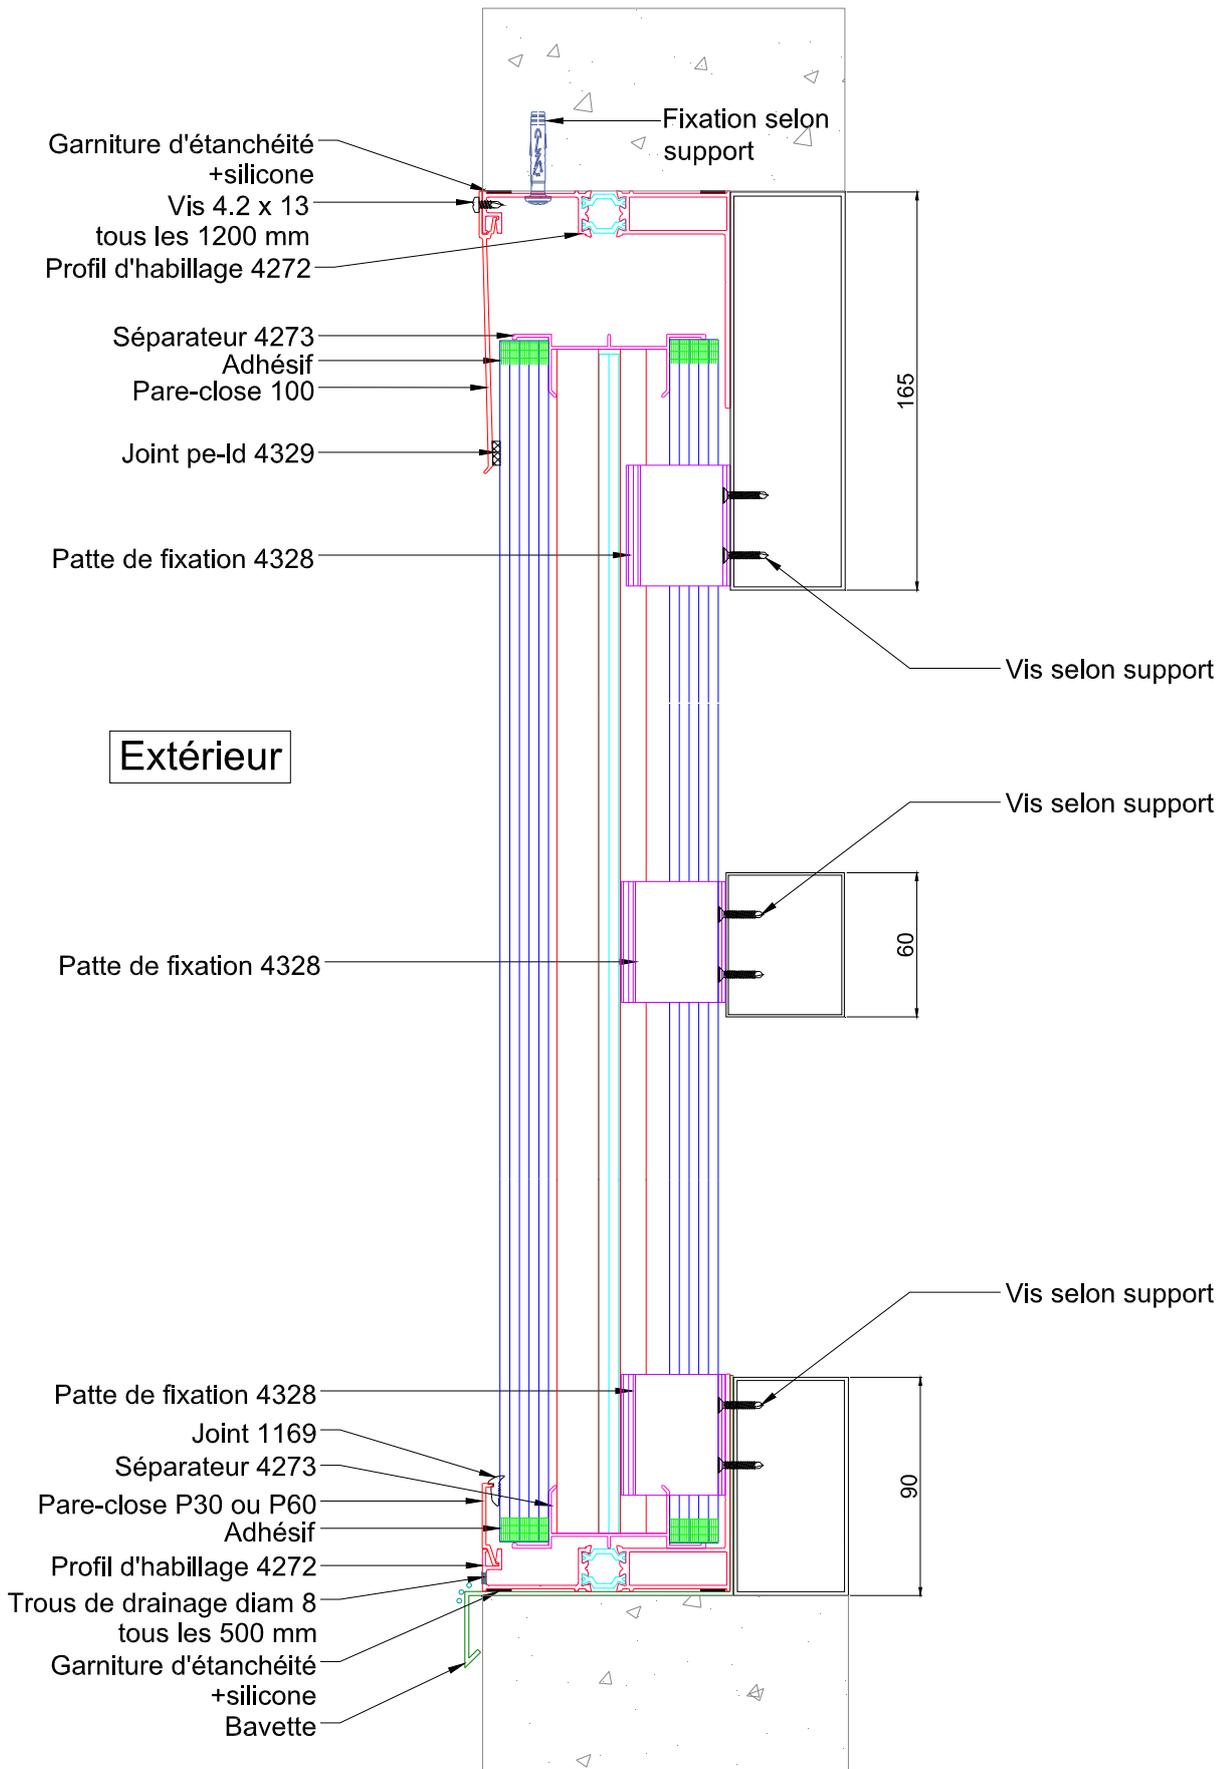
Pose en feuillure - Hauteurs de façade comprises entre 0 et 10 mètres -
